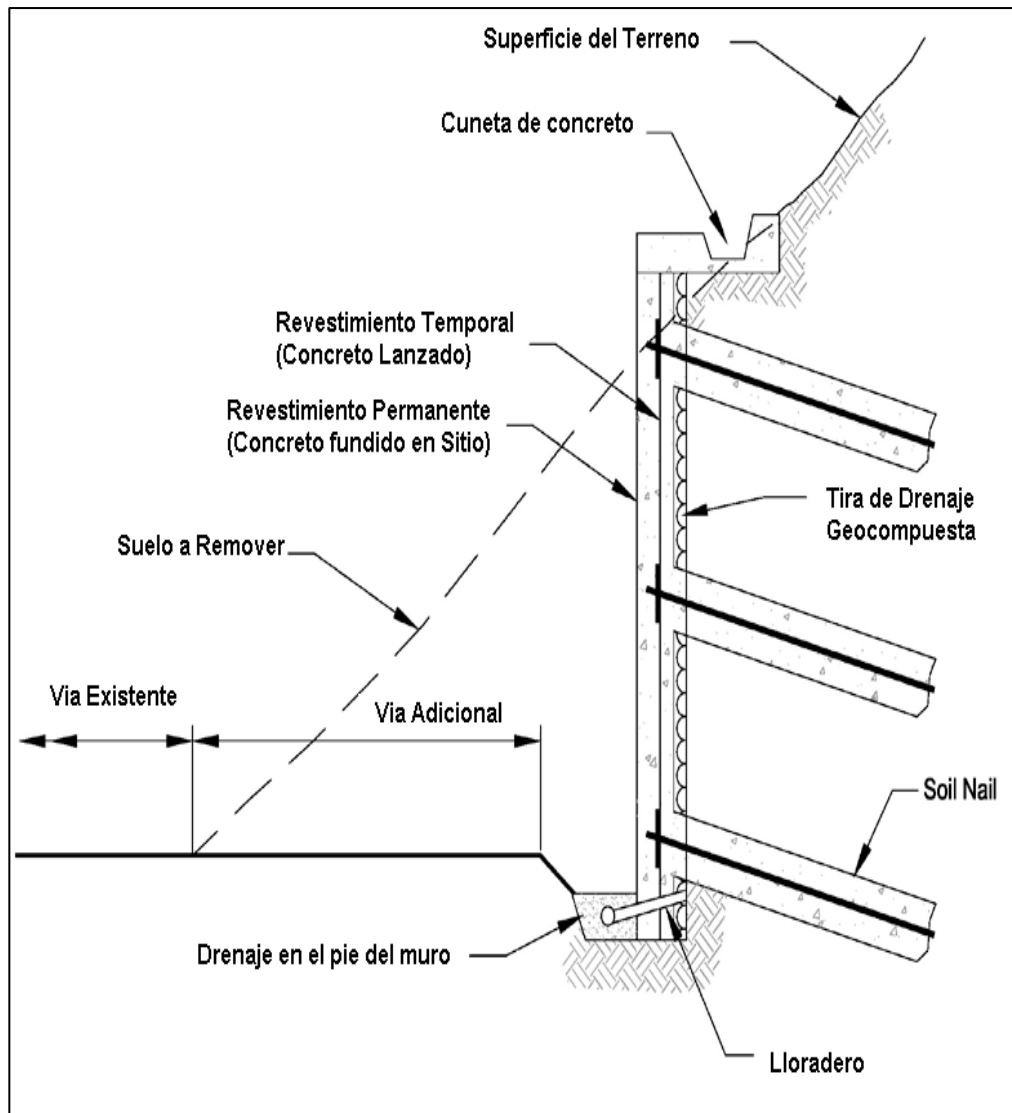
Muro de Soil Nailing permanente en ampliación de Vías.
